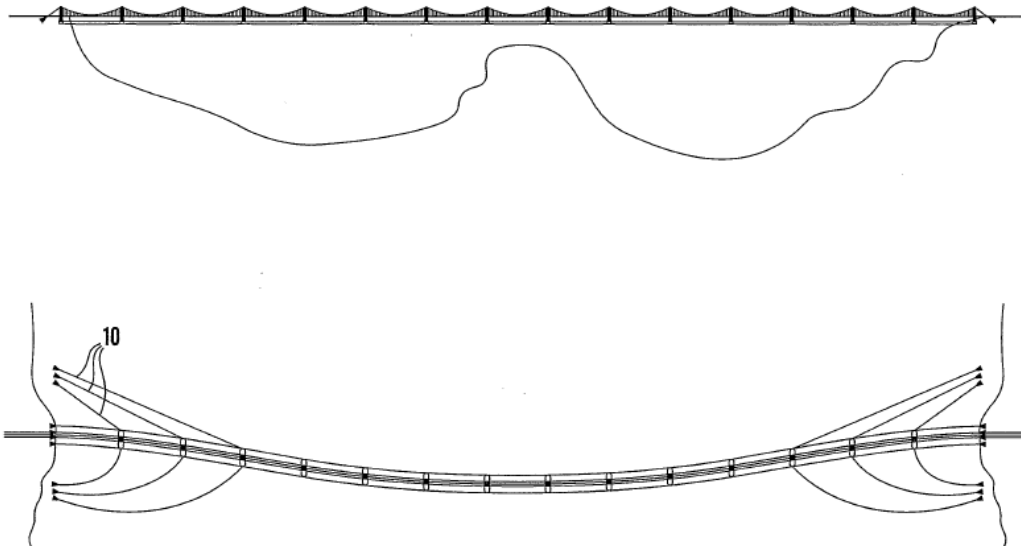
Ansicht und Grundriss, Variante 2 (Aardal, 2005)
